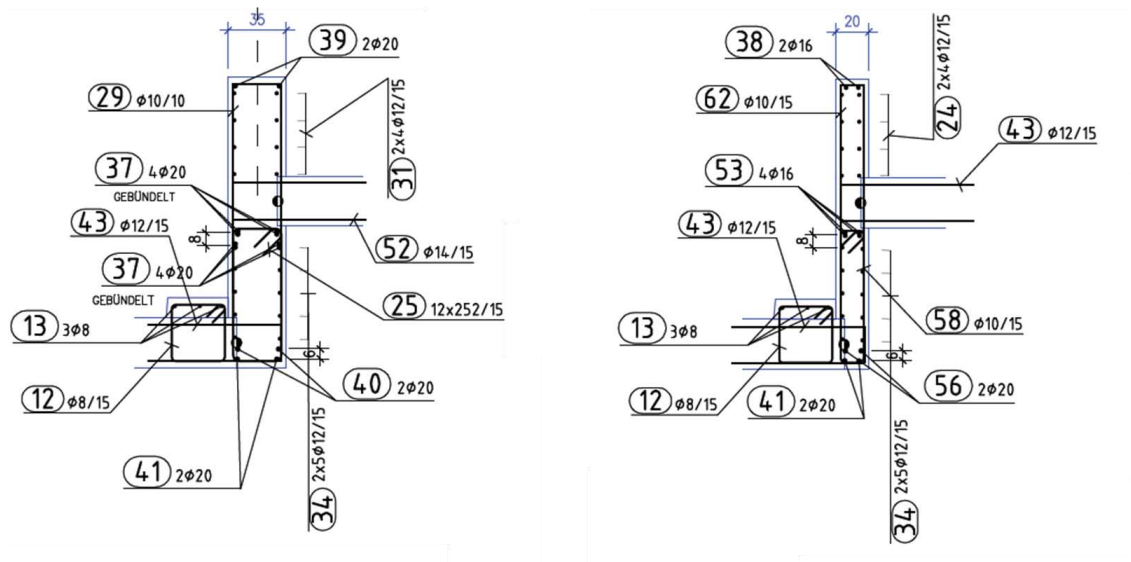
Auszug aus dem Bewehrungsplan von Rampenträgerpaar 1<sup>24</sup>
